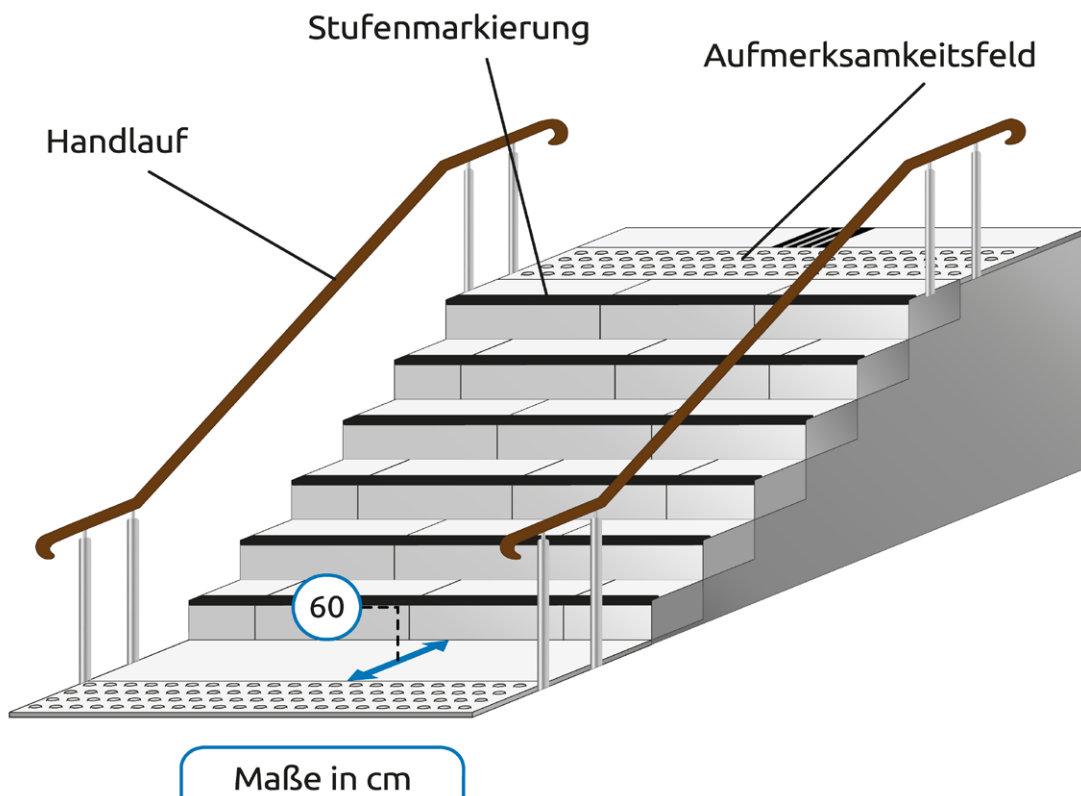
Treppe mit beidseitigem Handlauf, Stufenmarkierungen und taktiler Absicherung
